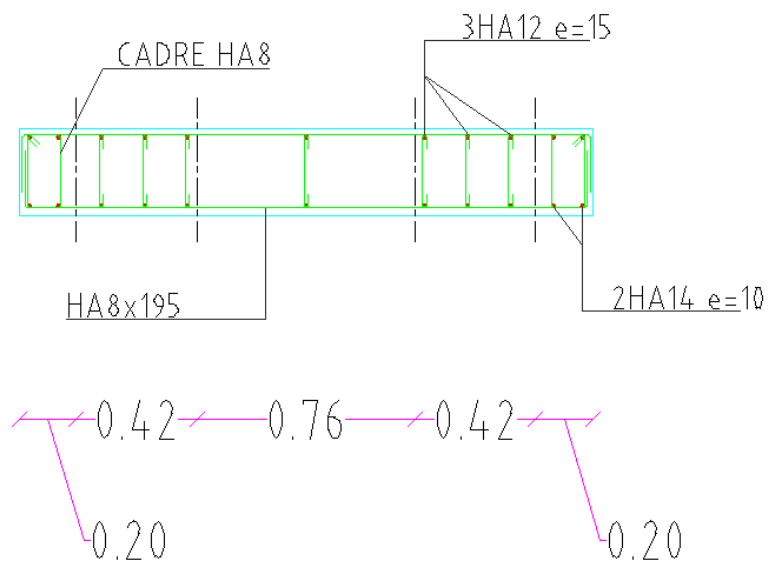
Ferrailages du voile plein coupe transversale
